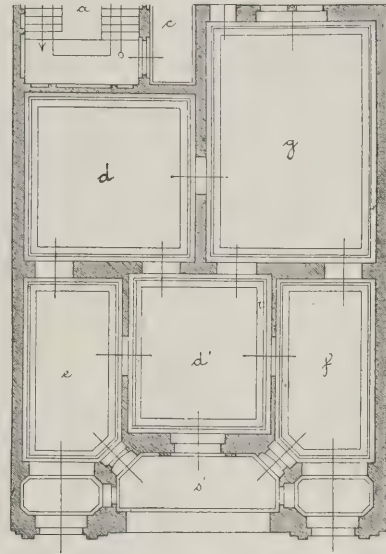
Villa in Berlin. Grundriß des I. Stockes.
